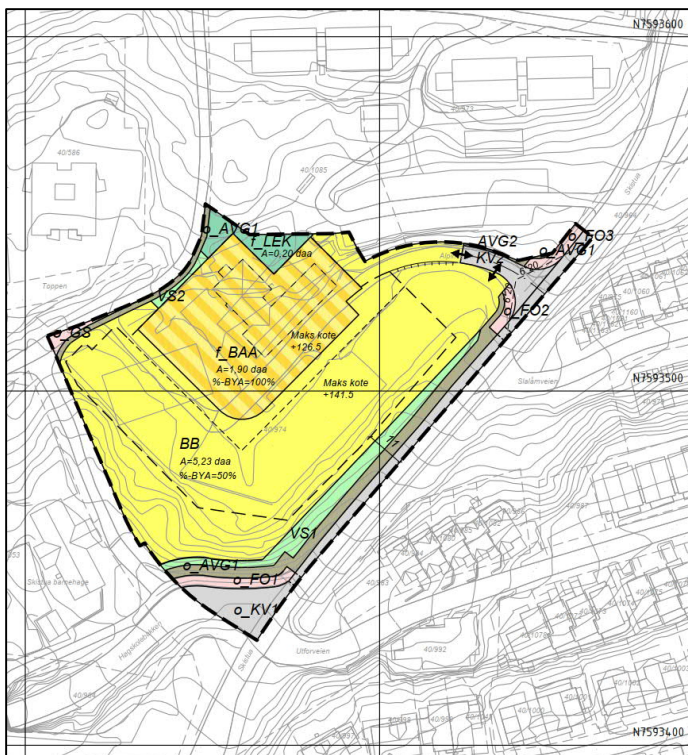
Situasjonsplan til planendring orientert mot nord. Kilde: Sweco Norge AS.
